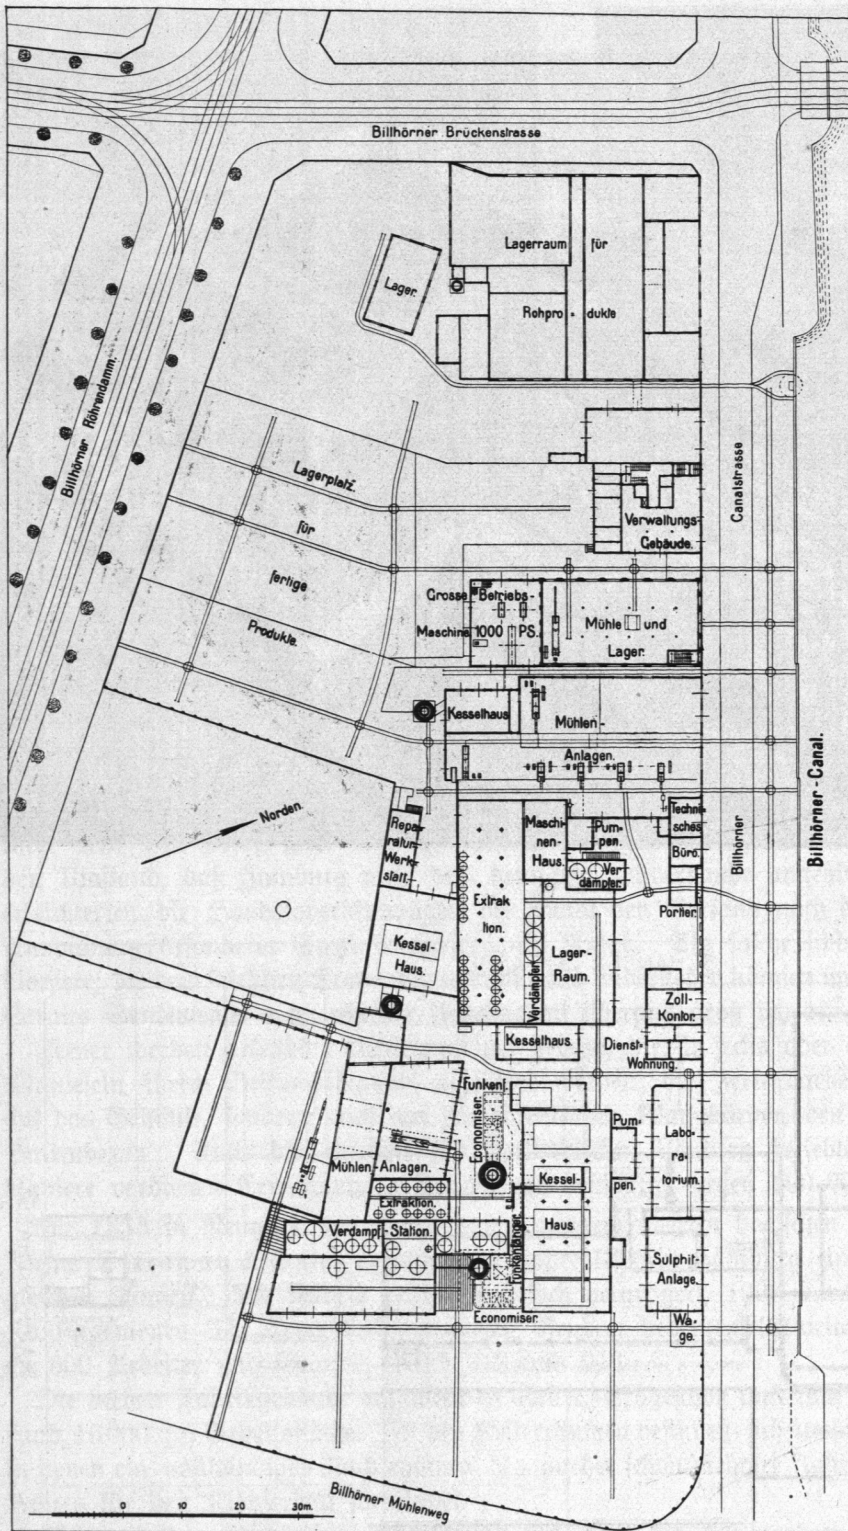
Gerb- und Farbstoffwerke H. Renner & Co. A.-G., Lageplan.
